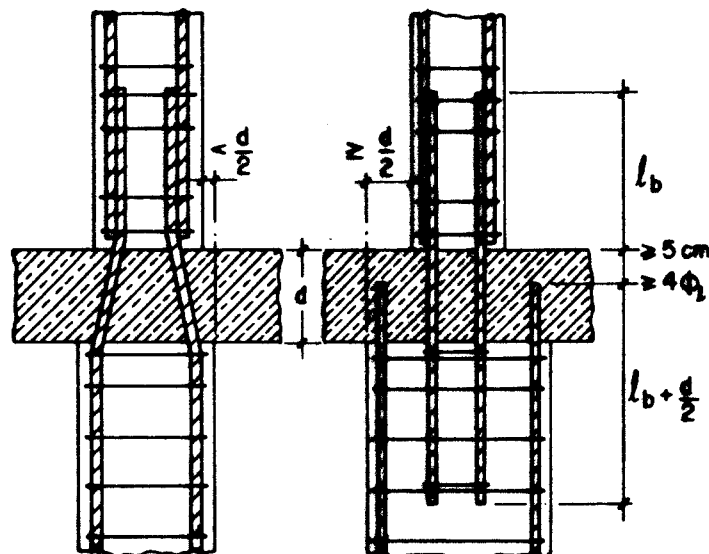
Emendas por traspasse junto a lajes de piso - pilar com seção variável^[20].
